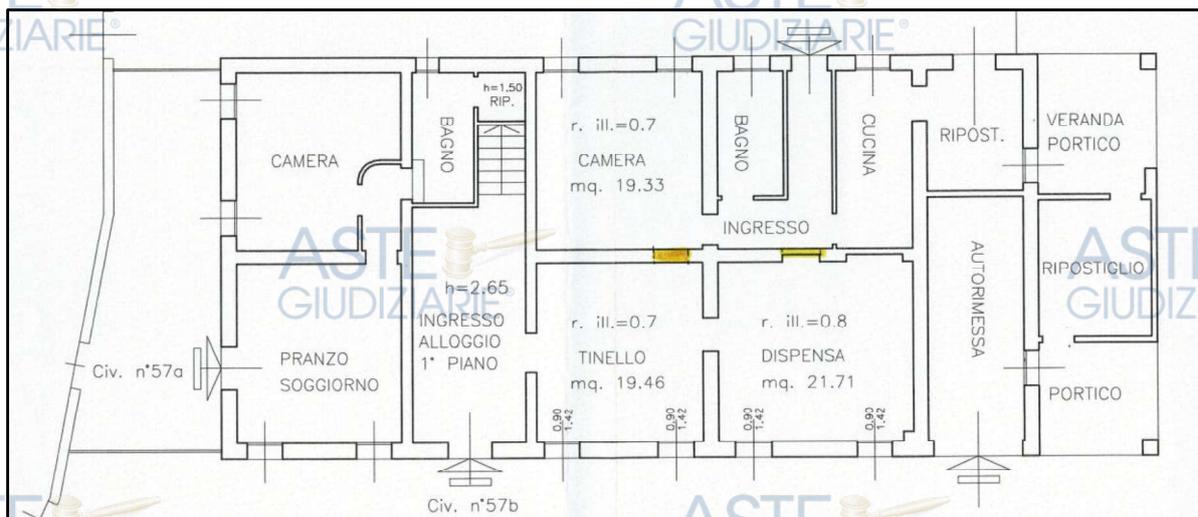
Estratto dalla DIA n. 195/66 – Stato di fatto (in giallo pareti da demolire)
